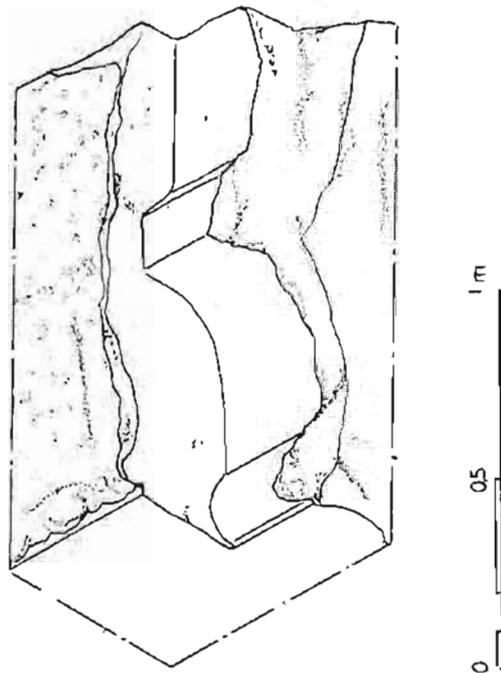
Inachèvement des moulures de la dalle de couverture.
